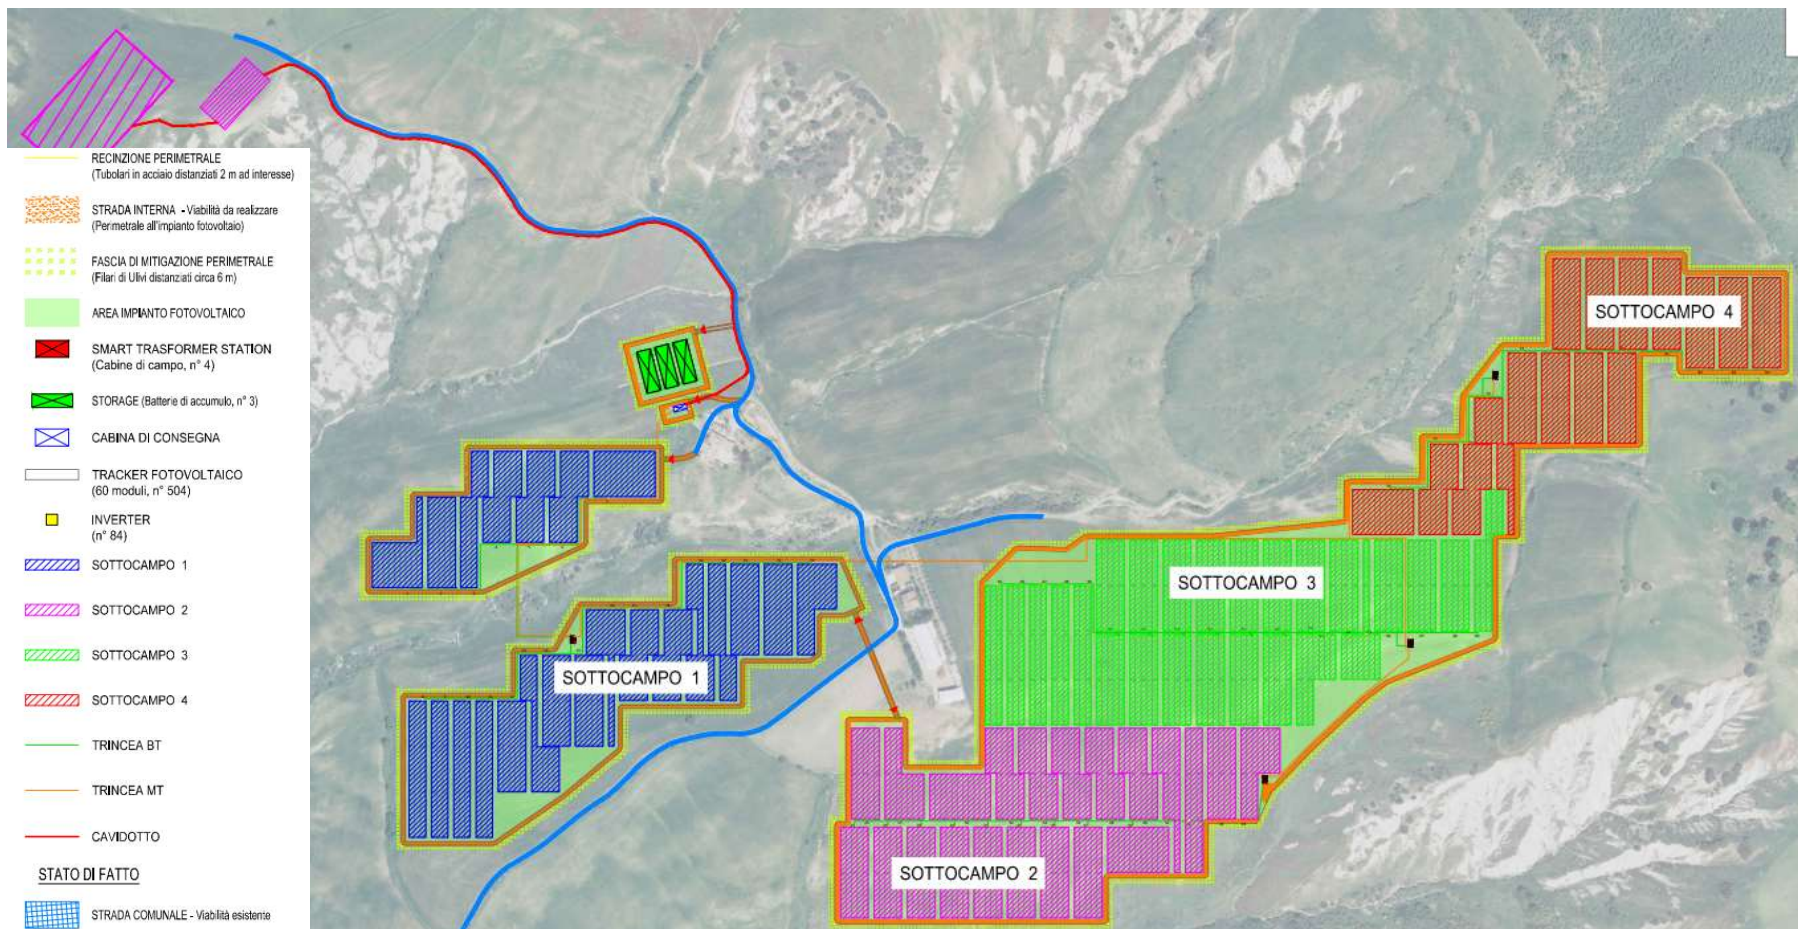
Stralcio planimetrico con indicazione dei sottocampi
